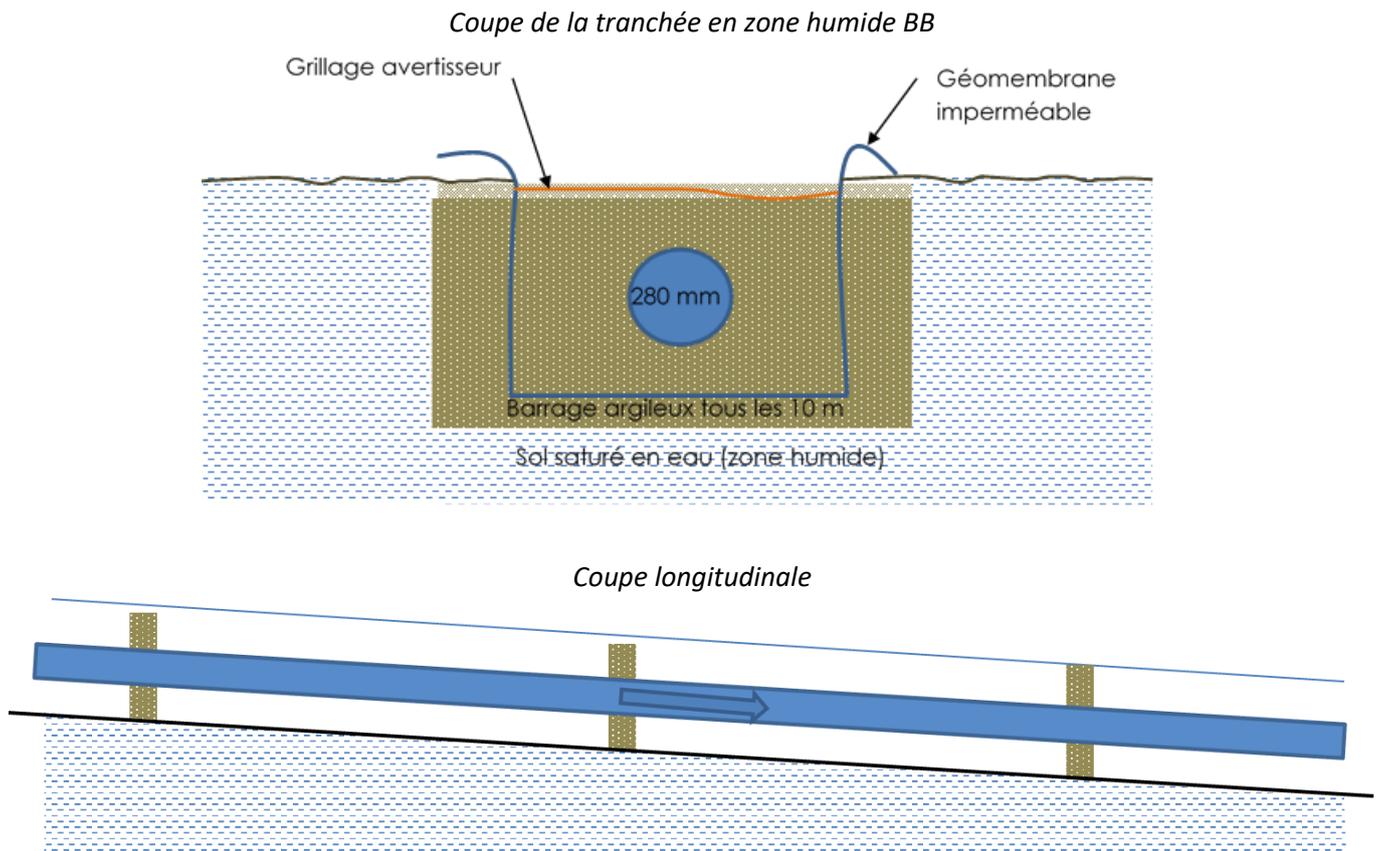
Plans de la tranchée des conduites avec disposition spécifique en zone humide
